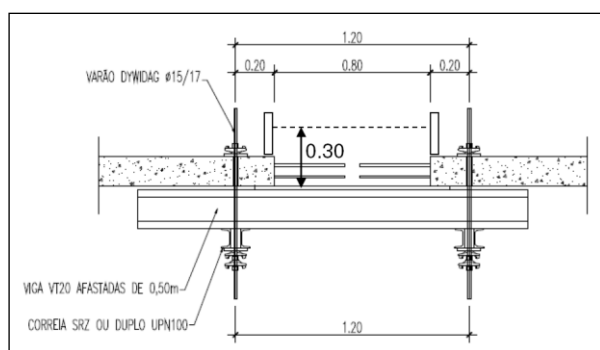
SISTEMA DE COFRAGEM DAS VIGAS DE UNIÃO DAS PRÉ-LAJES
